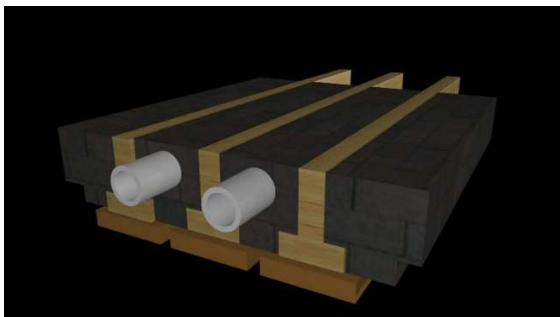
Entwurf für ein Deckenelement aus Holzträgern in T-Form und Holzbetonelementen
